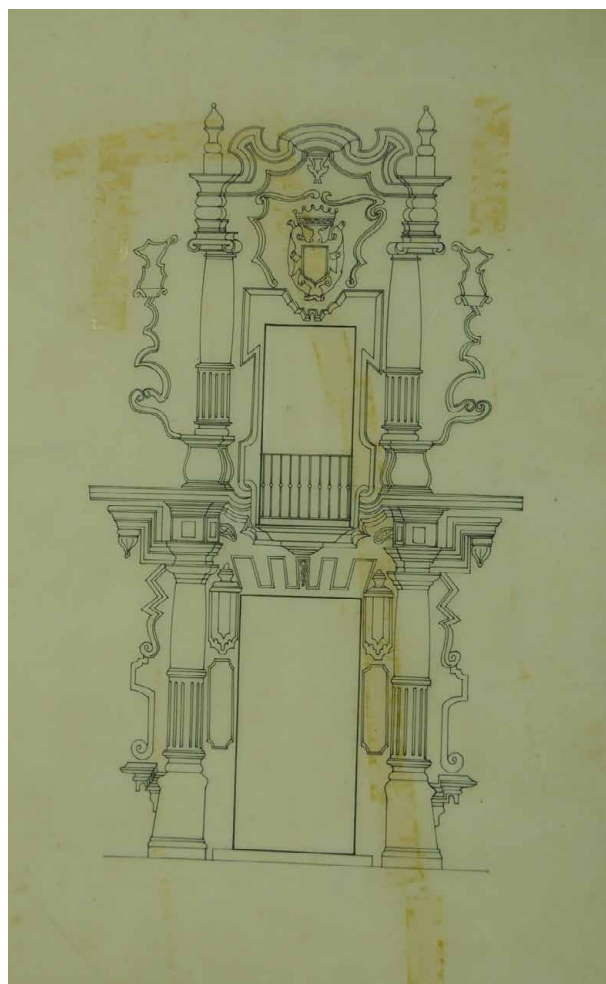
Dibujo de la portada del acceso por la calle Obrapía, tomado de: Centro de Información y biblioteca del CEN-CREM. Fondo Planos, exp. 03.04.1.3.0579.
